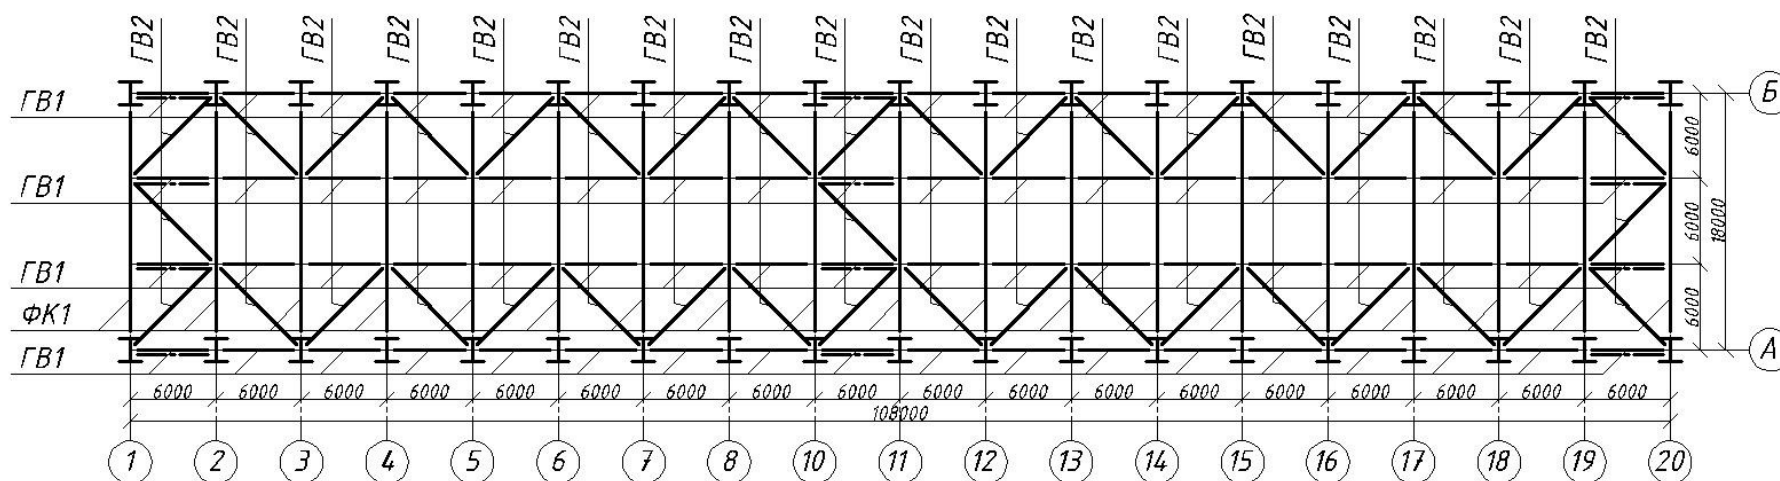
План в'язей по нижніх поясах кроквяних ферм
